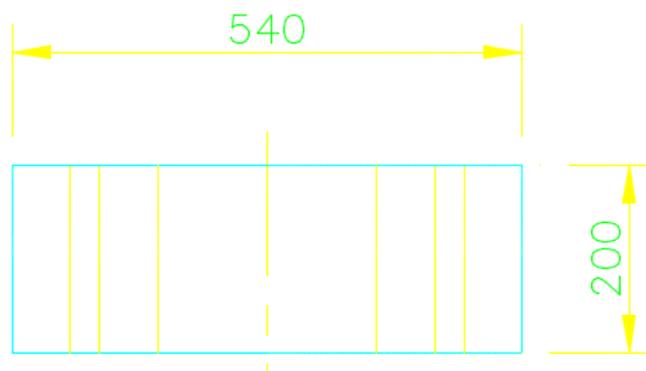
Ilustração da vista lateral do capitel utilizado para suporte da chave seccionadora de 500 kV.
